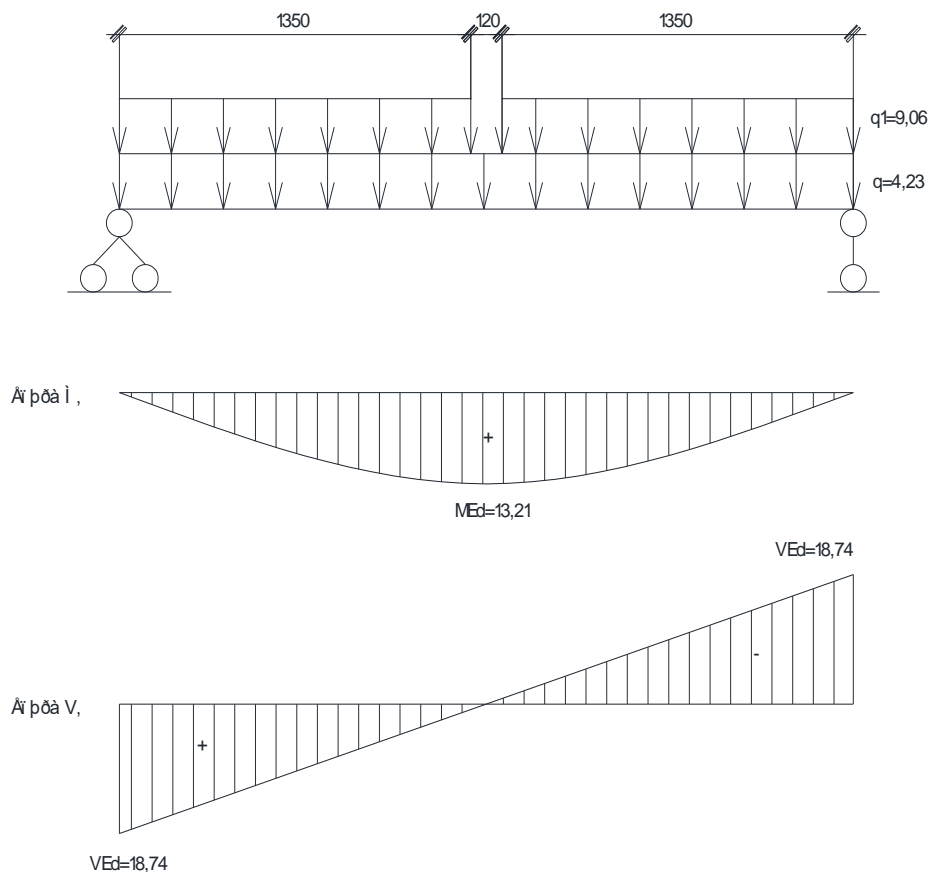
Конструктивна схема і схеми внутрішніх зусиль лобового ребра
